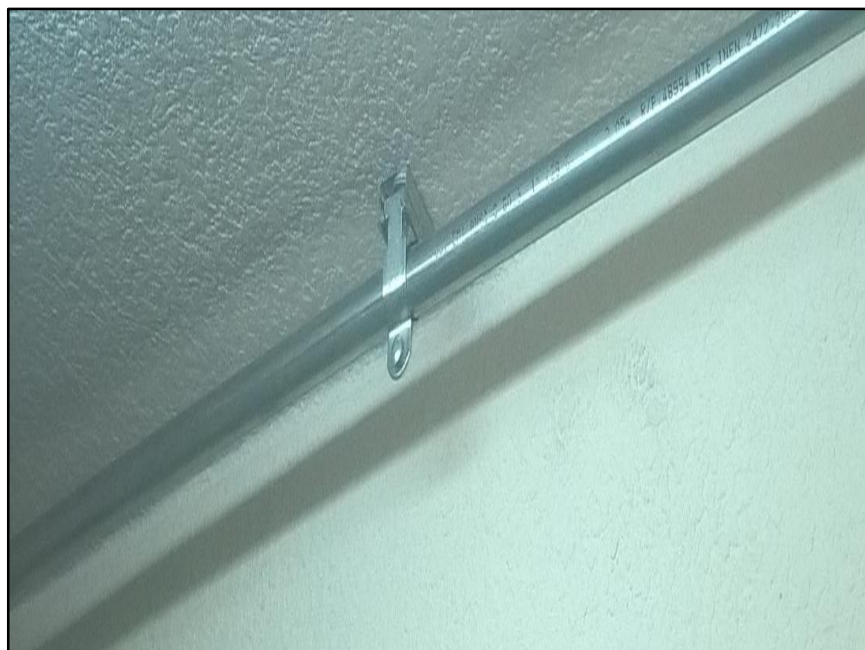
Tubería Conduit y abrazadera chanel instaladas
